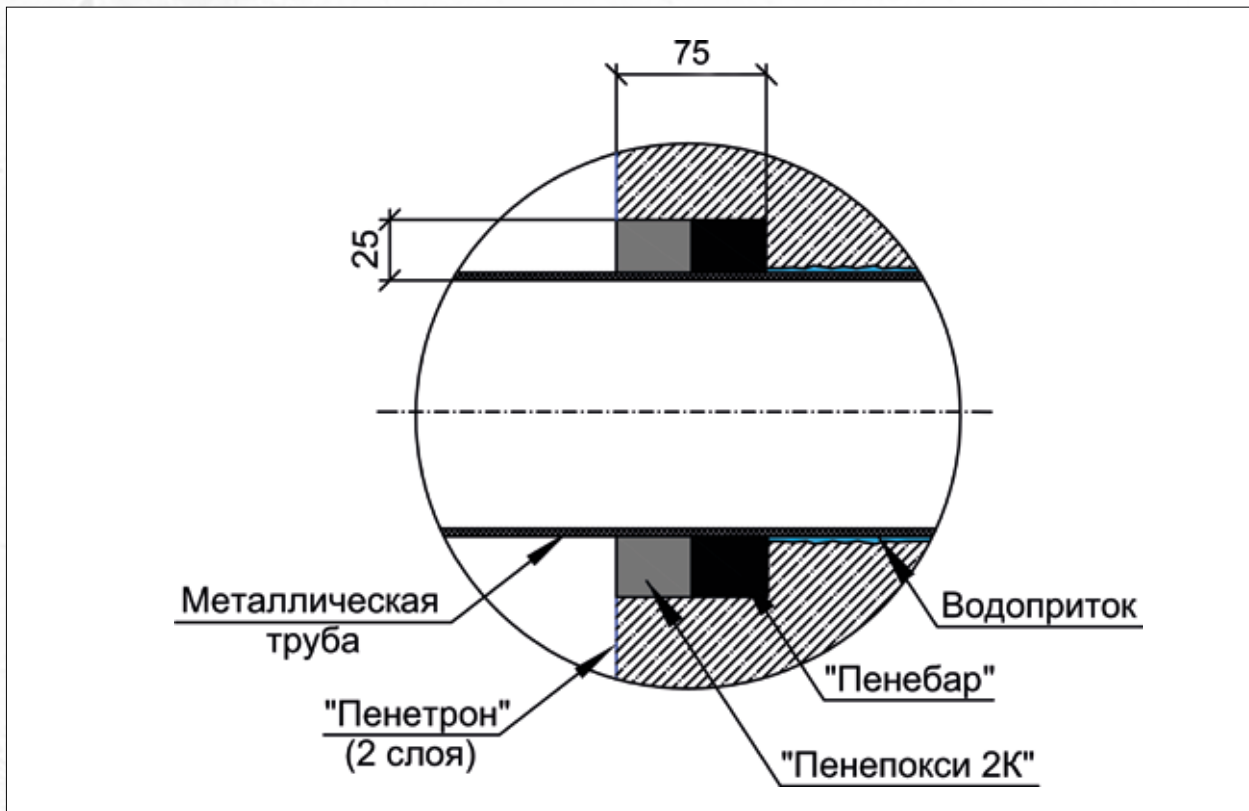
Гидроизоляция примыкания металлической гильзы к бетону
